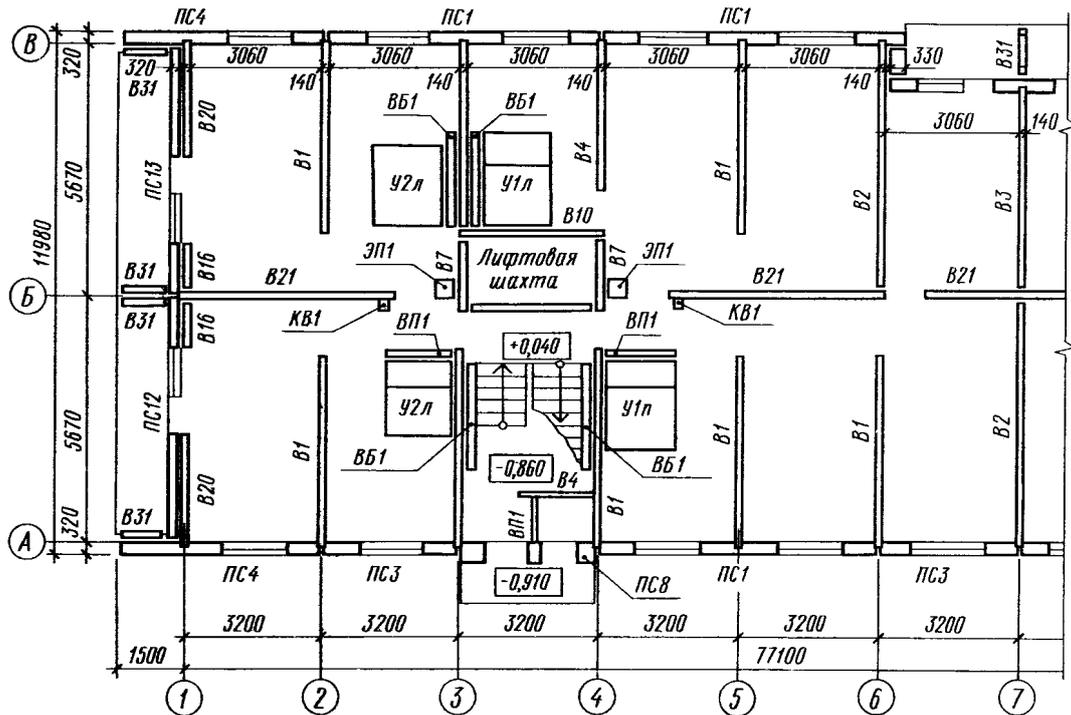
Схема расположения панелей на плане 1-го этажа
